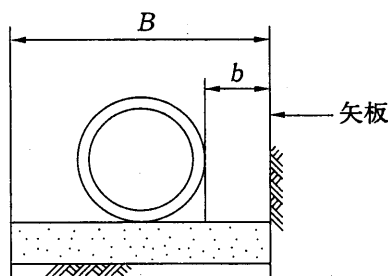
土基礎の標準掘削幅（矢板施工の場合）
